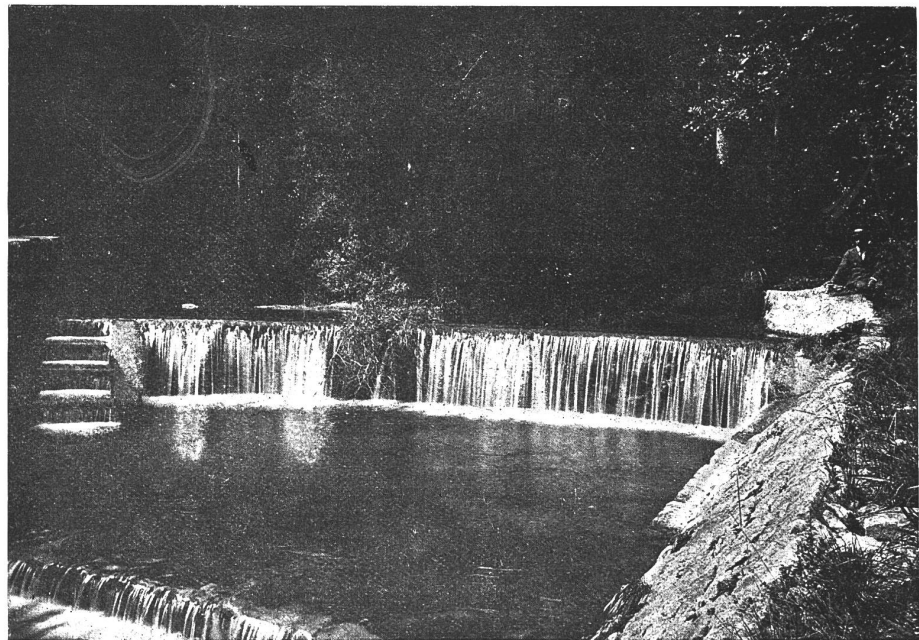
Barrage Tissot à Valangin. Echelle à poissons sur la rive droite.
